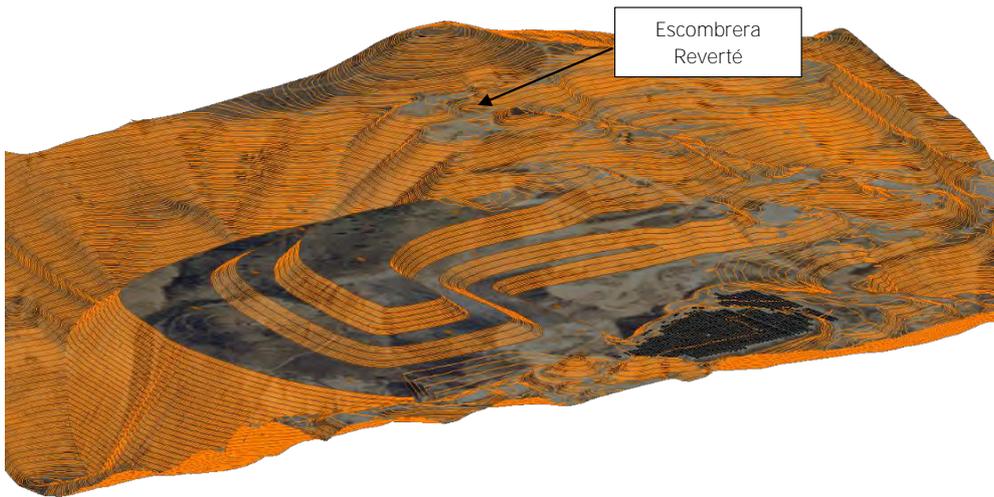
Estado Final Escombrera Pozo, según proyecto autorizado (PGR 2008) (II)
